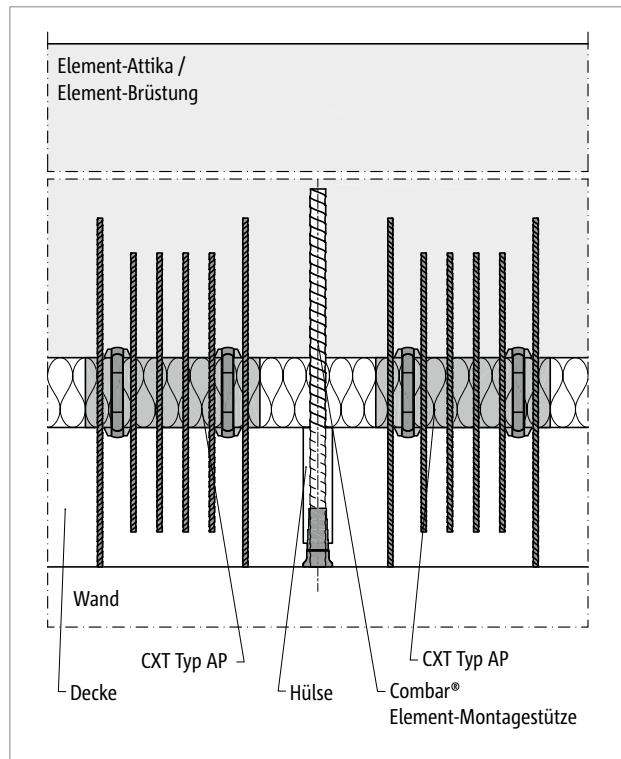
Schöck Combar® Element-Montagestütze: Einbau einer Elementattika; Ansicht
